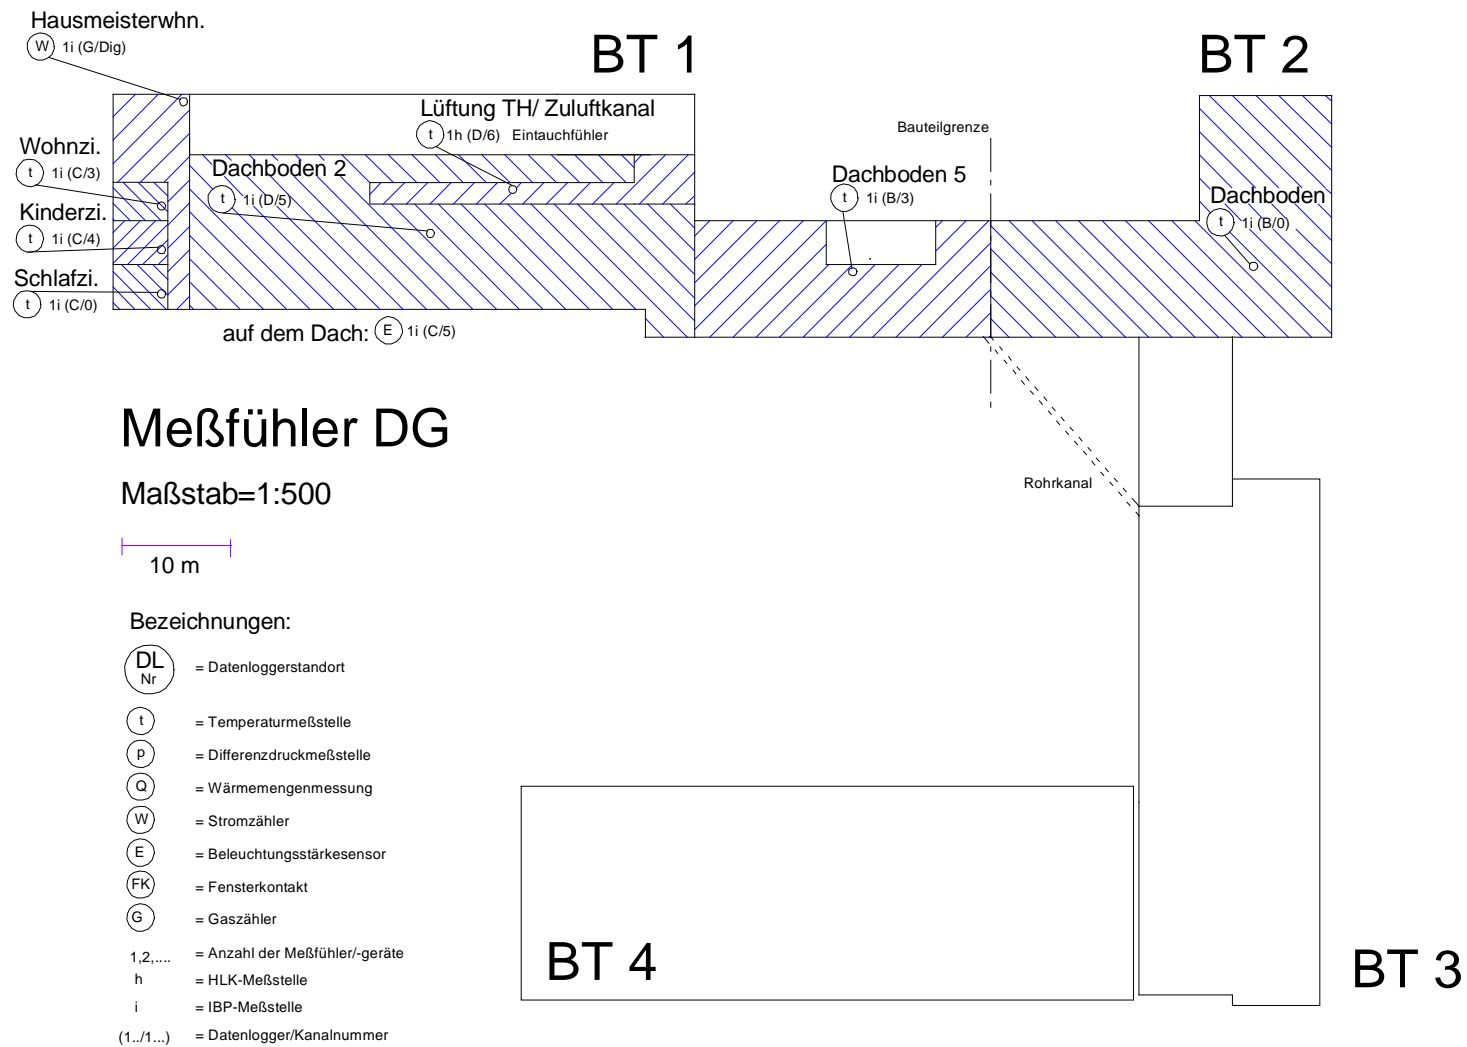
Ausführung und Ort der Messfühler im Dachgeschoss
